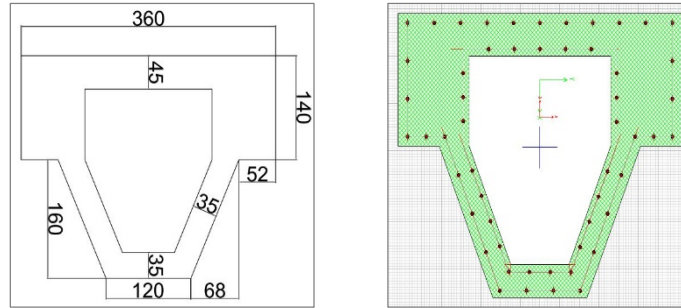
Dimensiones y distribución de refuerzo de la sección superior de las piernas de la torre en el tramo atirantado.
